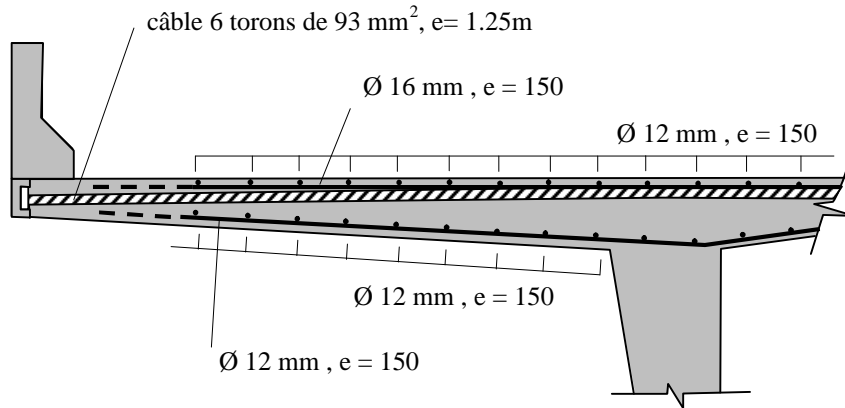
Coupe transversale et armature du porte-à-faux.
